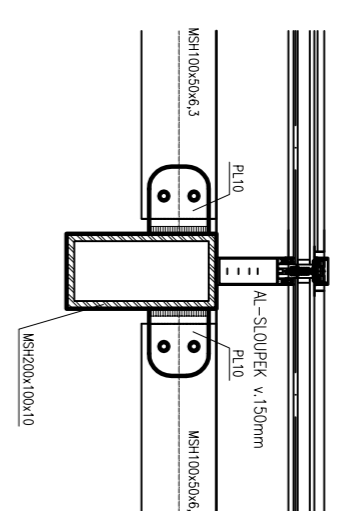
DETAIL MADPRAŽI STŘEŠNÍHO OKNA
